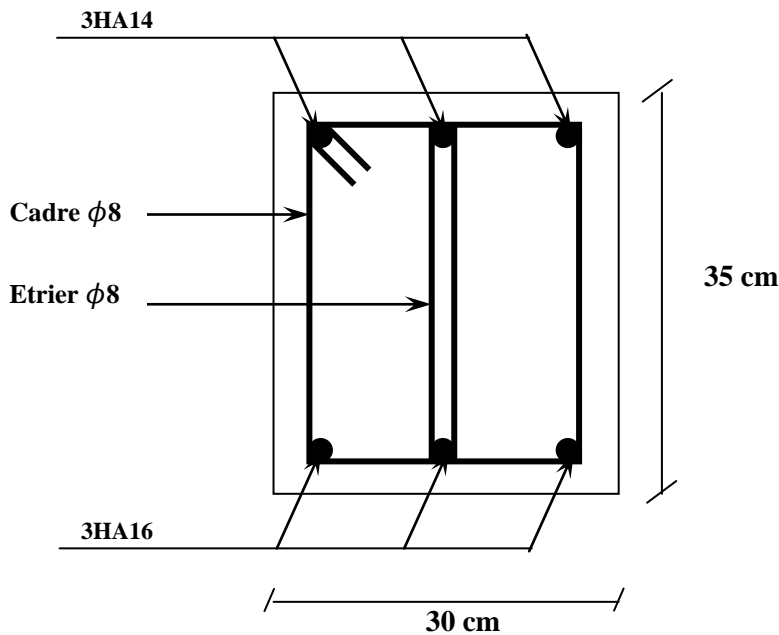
Schéma de ferrailage de la poutre brisée.
